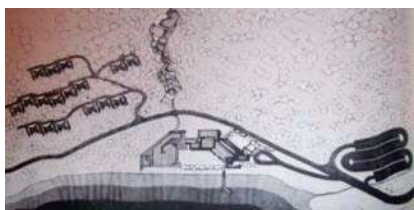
Planta de conjunto los Azufres, libro Oficio de Arquitectura.
